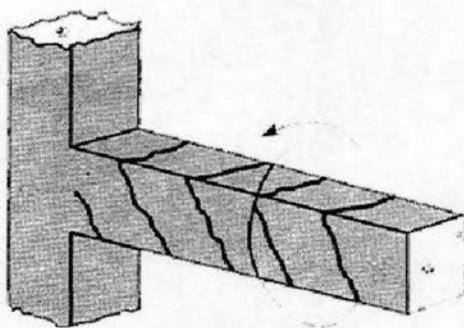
Fisuras debido a la torsión
